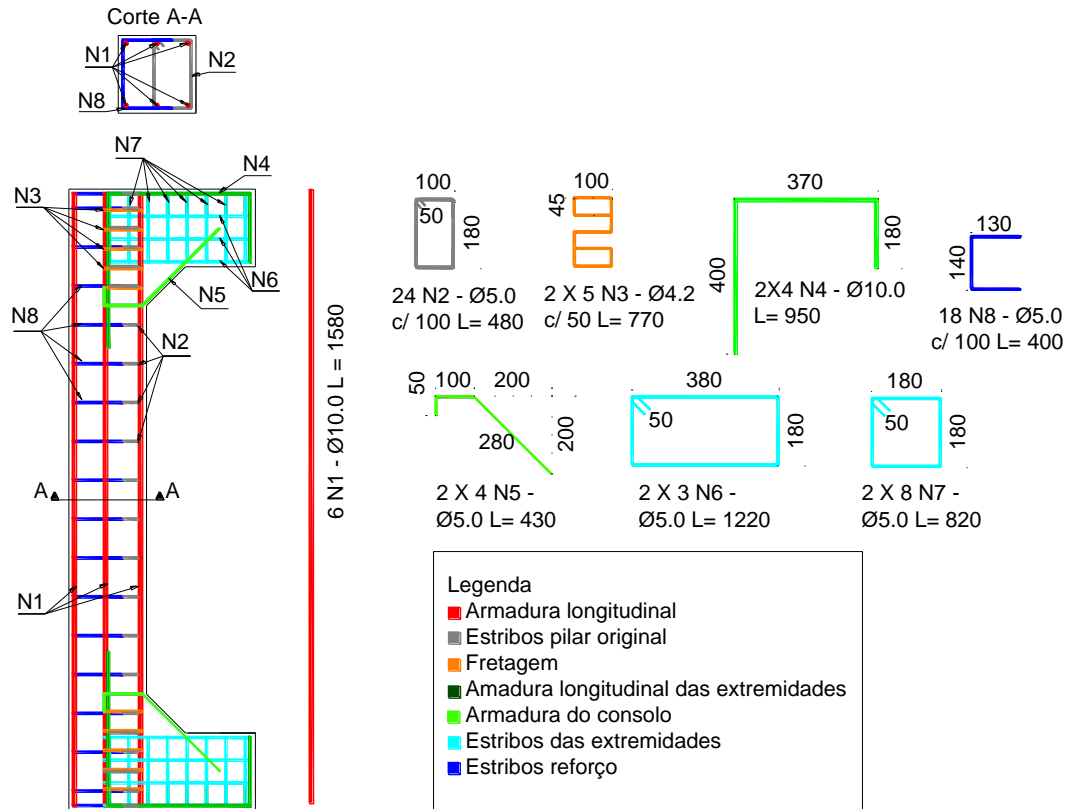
Detalhamento da armadura dos pilares de referência e reforçados à tração
